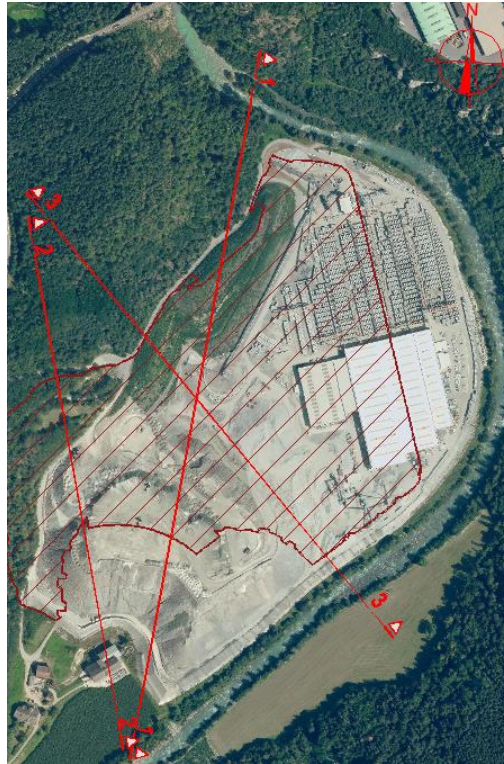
Vista in pianta del deposito di Hinterrigger con ubicazione delle sezioni di raffronto
